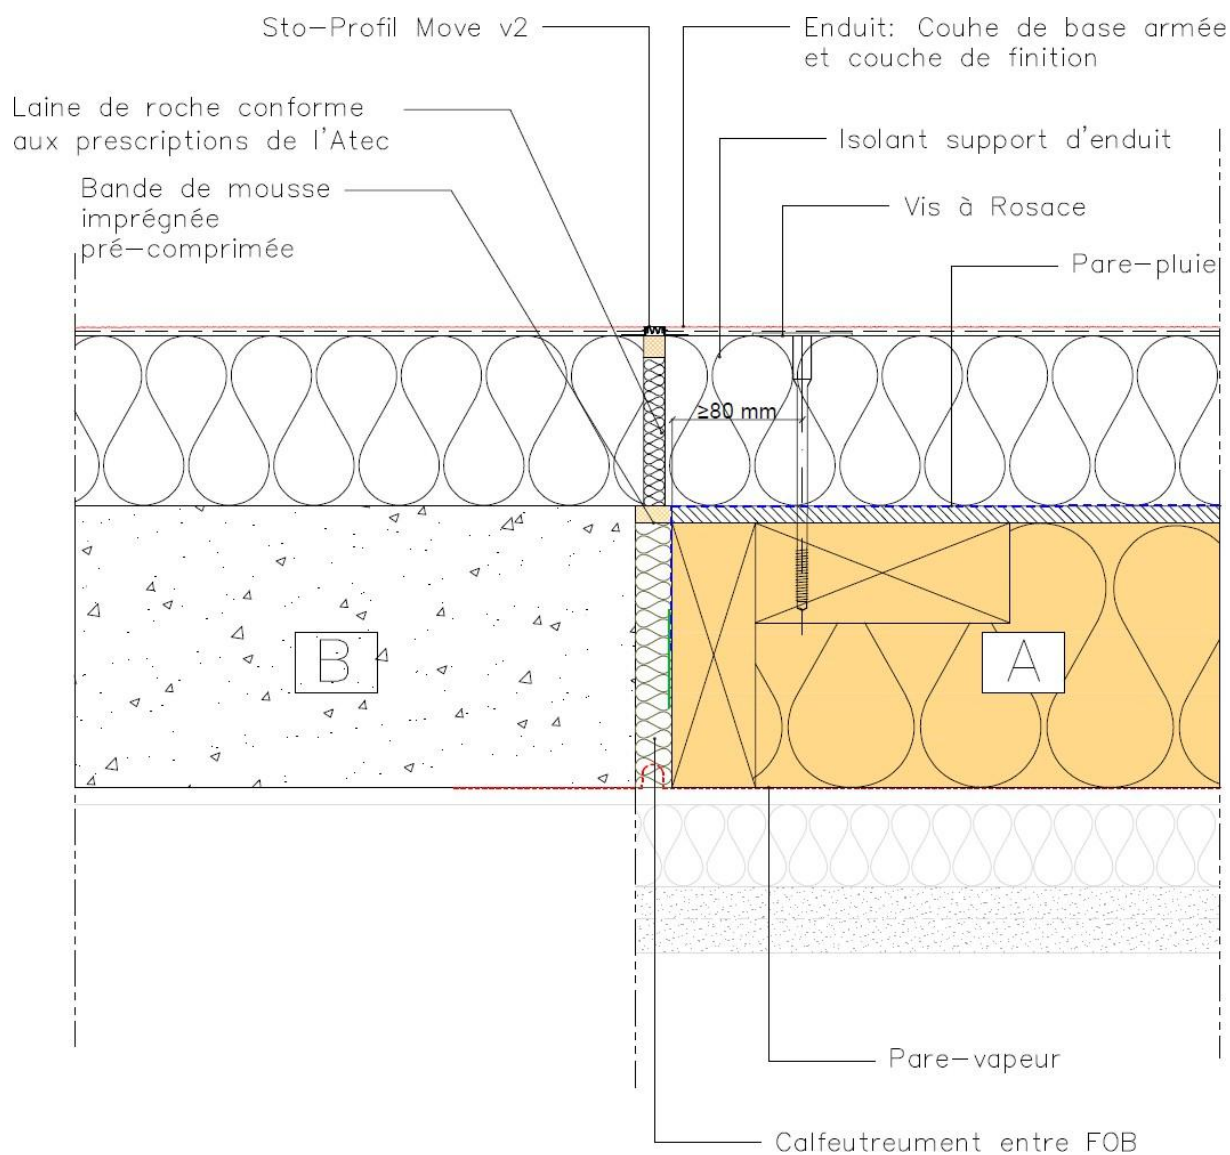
Jonction FOB / Voile BA (ou maçonnerie) dans le même plan et avec ETICS - Sto-Profil Move2 - Coupe Horizontale
